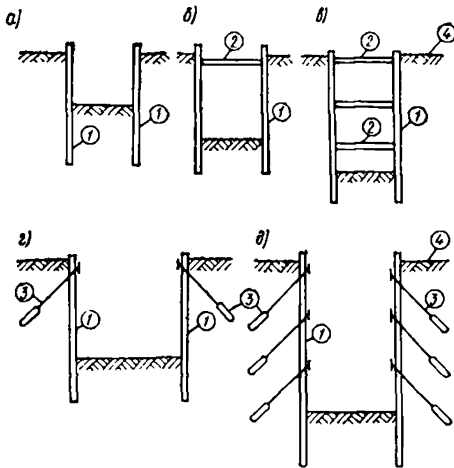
(1). Конструктивные схемы стен подземных (прямоугольных в плане) сооружений
